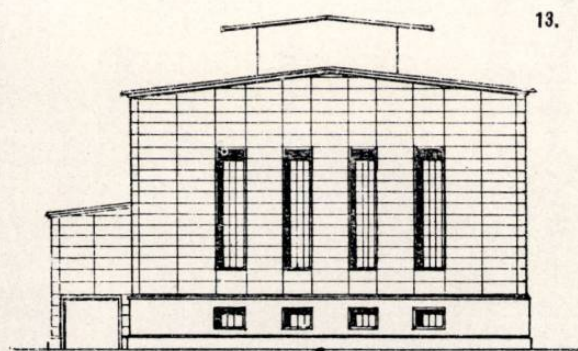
Fațada frontală. Plăci și ferestre prefabricate din beton armat.
